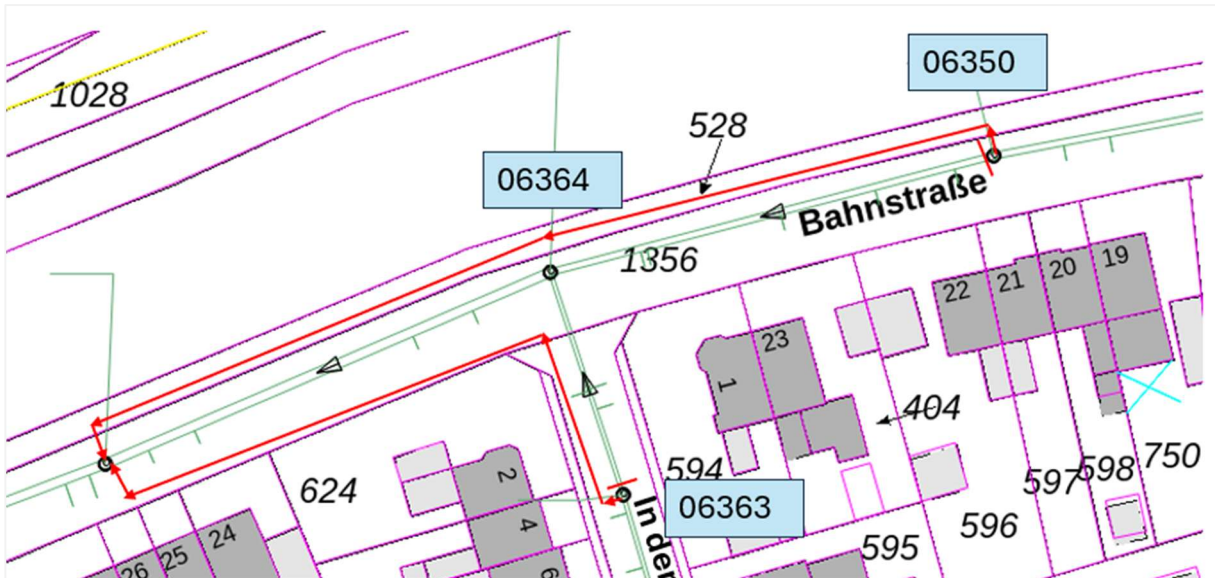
Abwasserüberleitung Bauabschnitt 1
